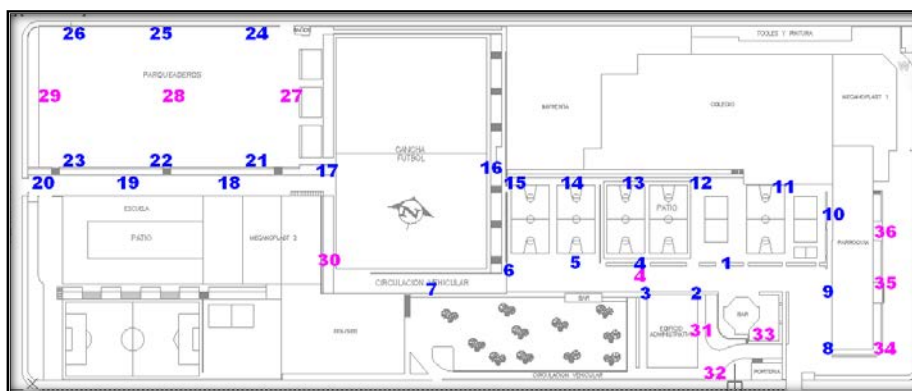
Nuevas Luminarias ubicadas en el plano¹⁵⁵
